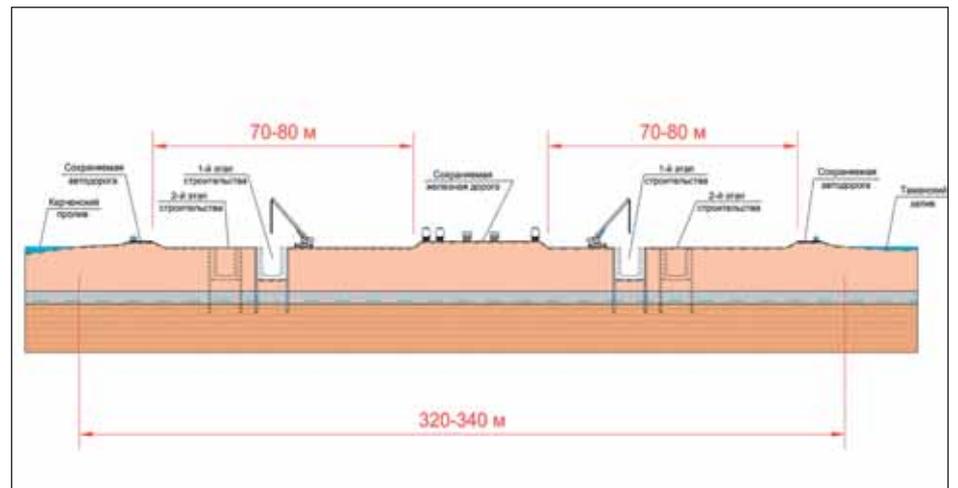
Разрез по стройплощадкам открытого способа работ на косе Чушка
